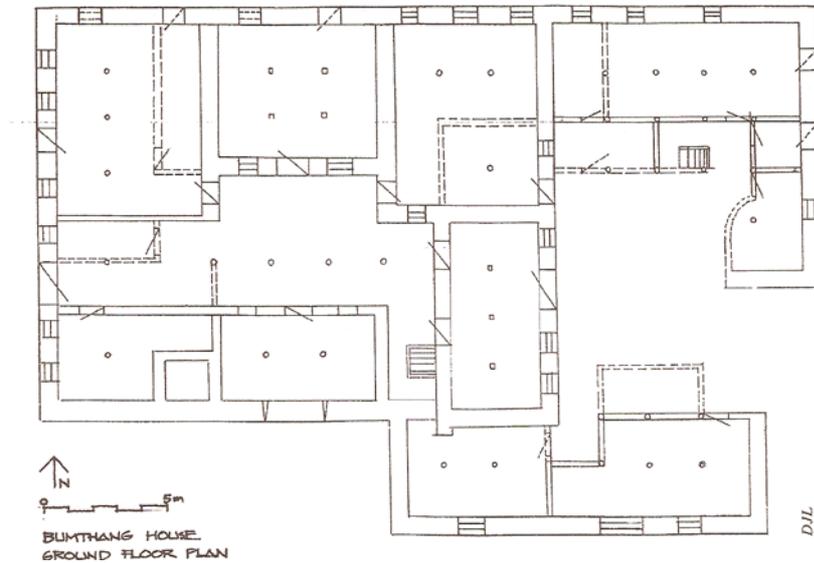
Chongye Bumthang, Lhasa, Grundriss EG (Alexander/de Azevedo 1998)
